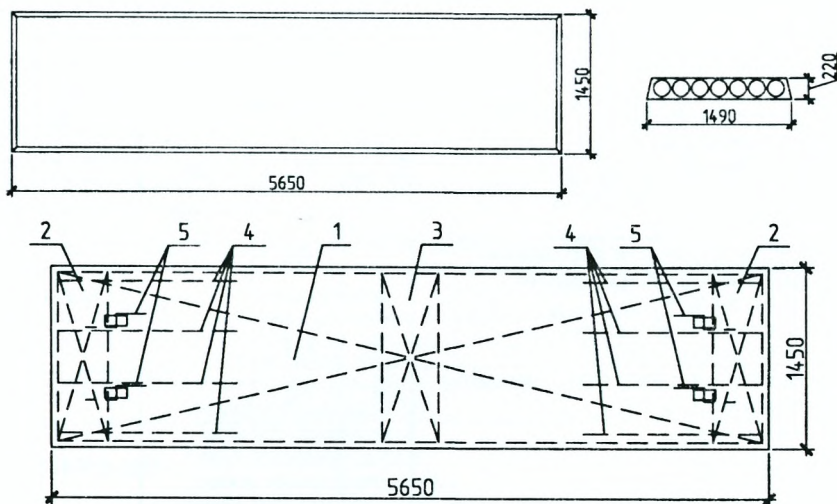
Сборная железобетонная многопустотная плита ПК56.15-6АтV-Б
